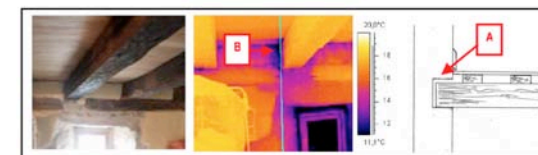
cas d'un plancher simple à poutres encastrées apparentes (bâtiment 7) :
